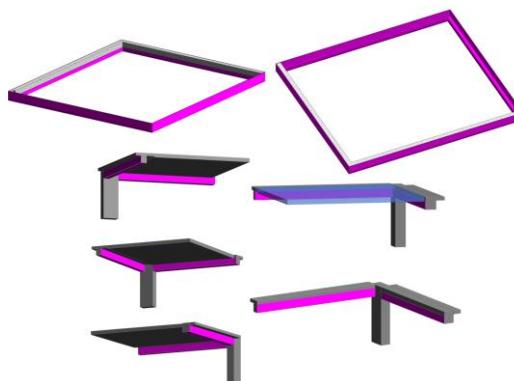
Modelado automatizado de laterales de vigas con losa, color ‘magenta’
